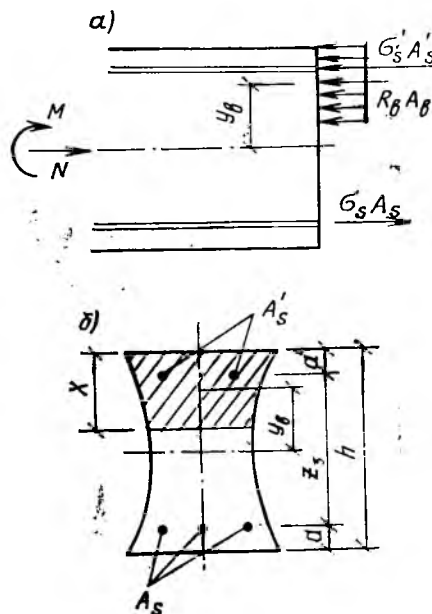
Схема усилий (а) и эпюра напряжений (б) железобетонного элемента
